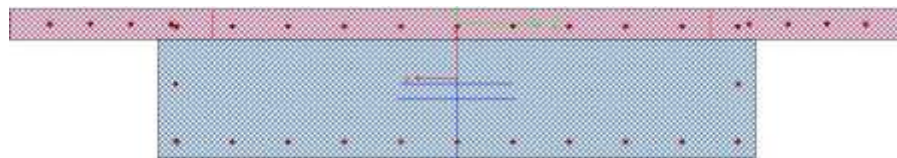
Sección transversal la viga longitudinal del puente estudiado. Fuente: Elaboración propia.
